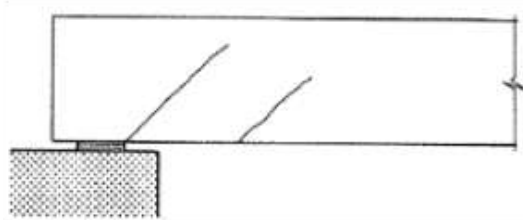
Fisuras producidas por fuerza de corte por tracción diagonal.
